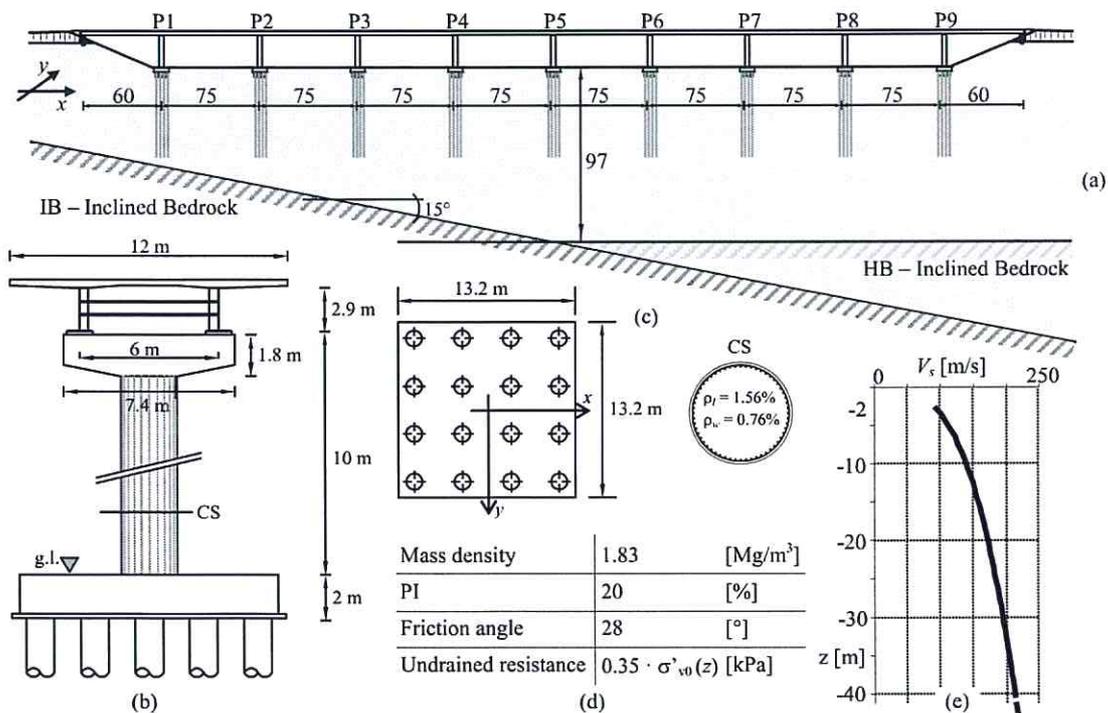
(a) Vista laterale del viadotto; (b) Pila in elevazione; (c) Sistema di fondazione e sezione dei pali, (d) Proprietà meccaniche del terreno (e) Profilo delle velocità V_s fino a 40 m di profondità.
